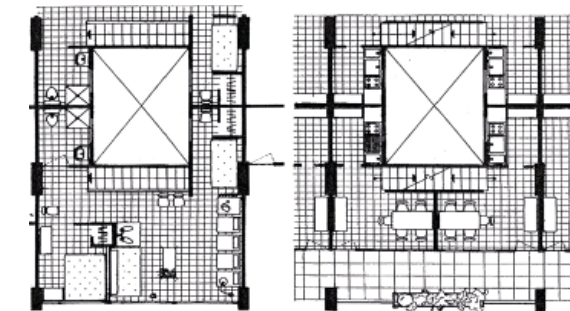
Plantas tipo, Centro Urbano Presidente Alemán.
